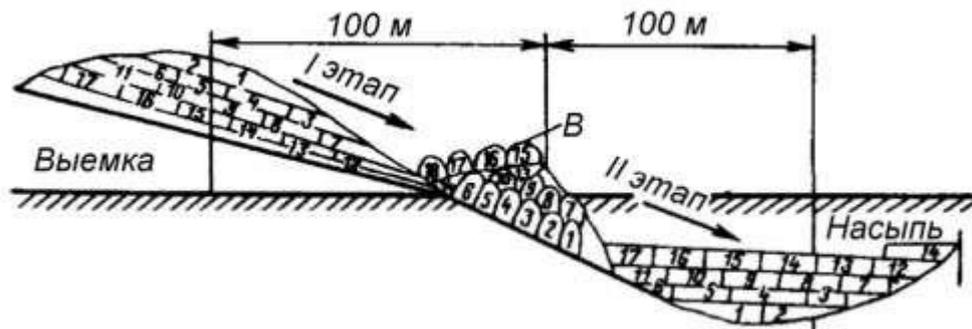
Условная Схема способа перемещения грунта в два этапа
